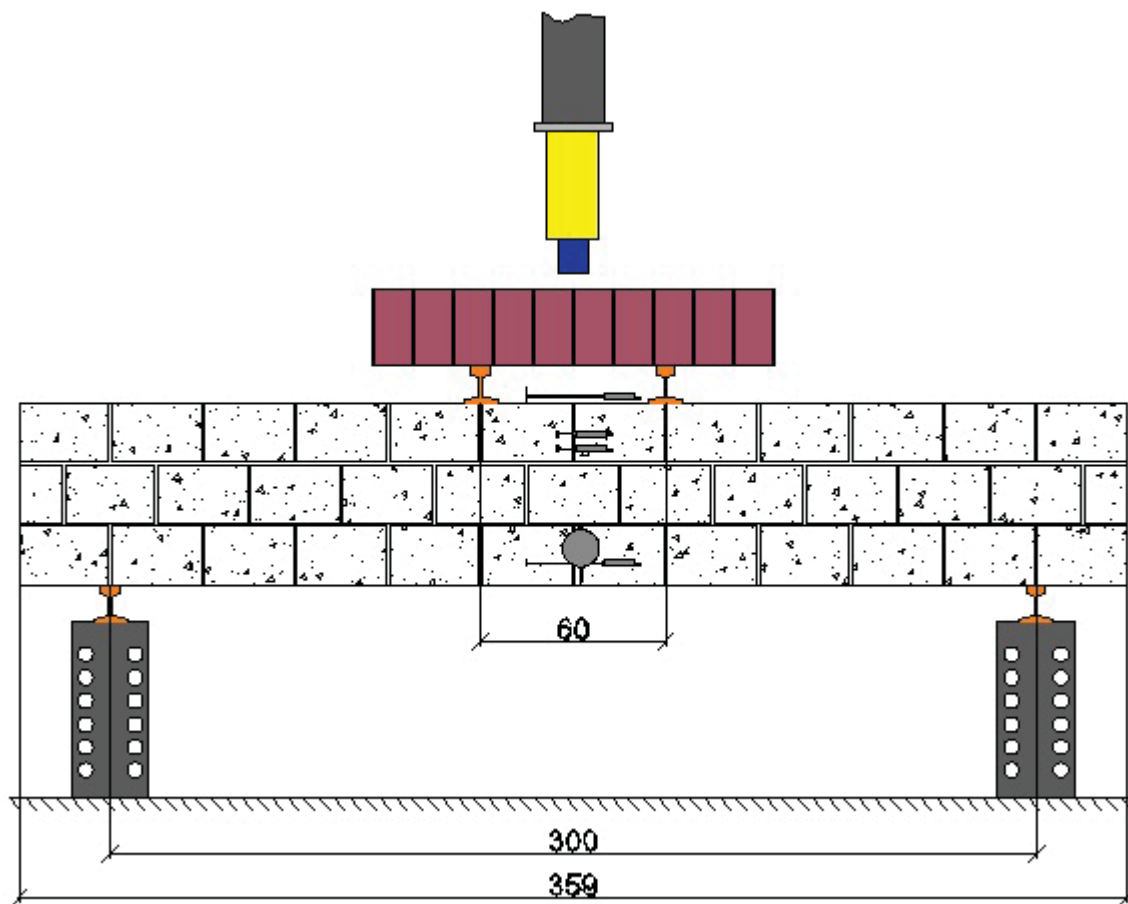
Esquemas utilizados para os ensaios das vigas de alvenaria estrutural armada – Dimensões em centímetros
